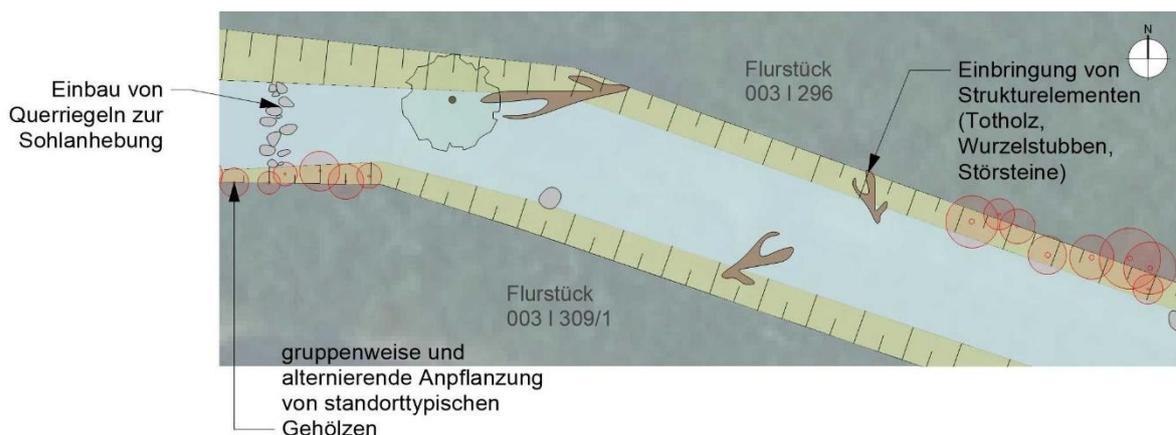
Strukturelemente und Querriegel im Planabschnitt 4 (Ausschnitt, beispielhafte Darstellung)
